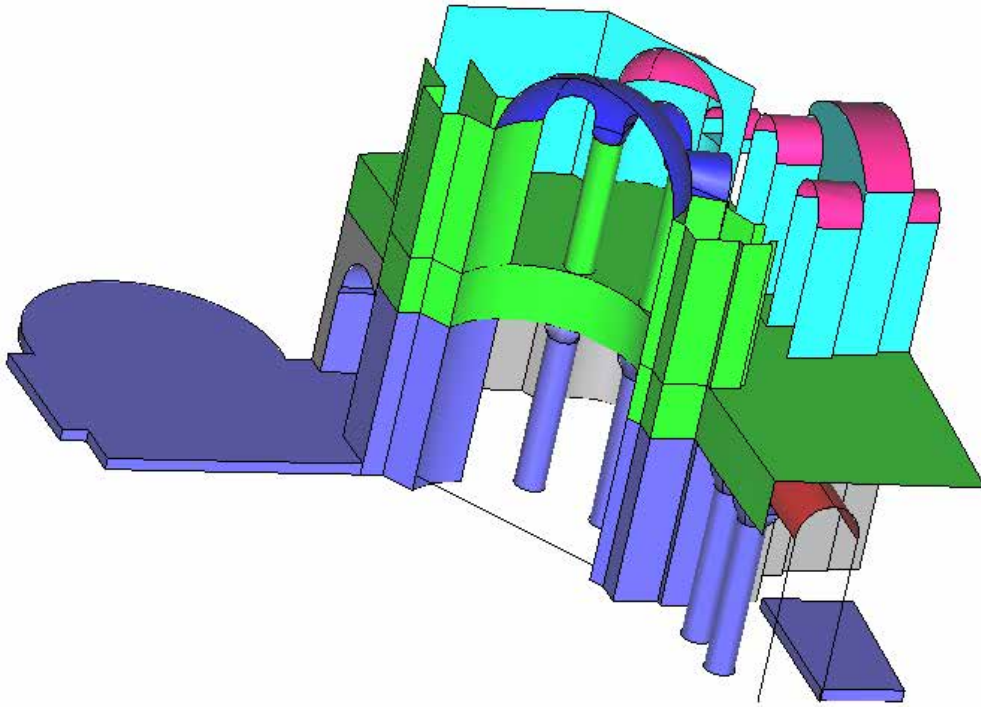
Creación geometría planta baja y primer piso (vista interior)
